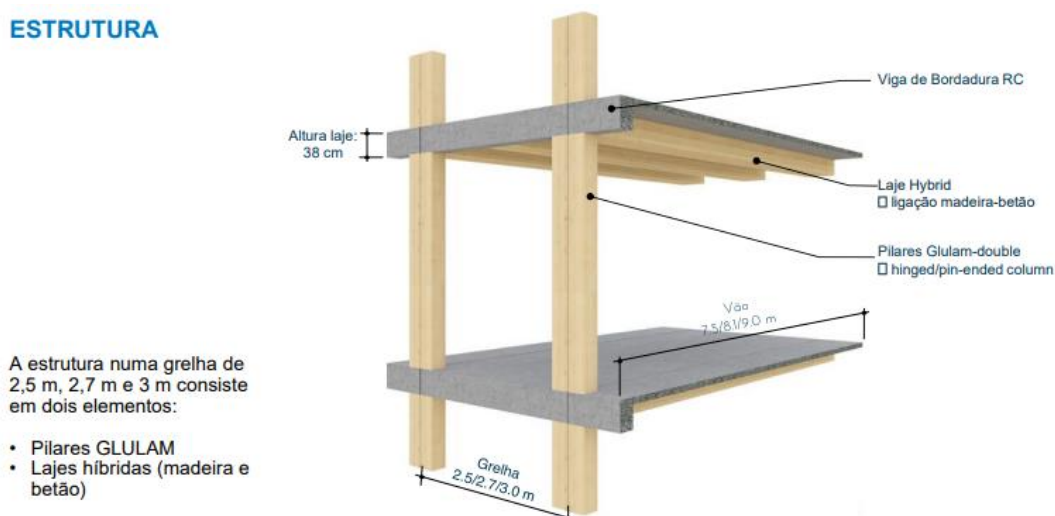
Esquema Estrutural – Fonte: Adaptado De CREE © 2018 + Casais
